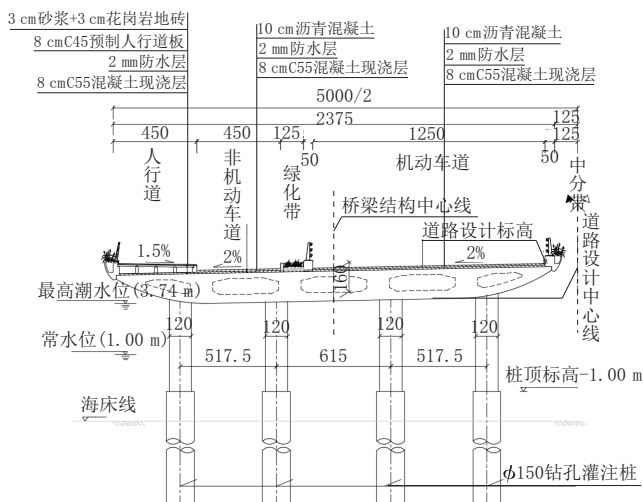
矮墩预应力连续刚构桥梁横断面布置图(单位:cm)
